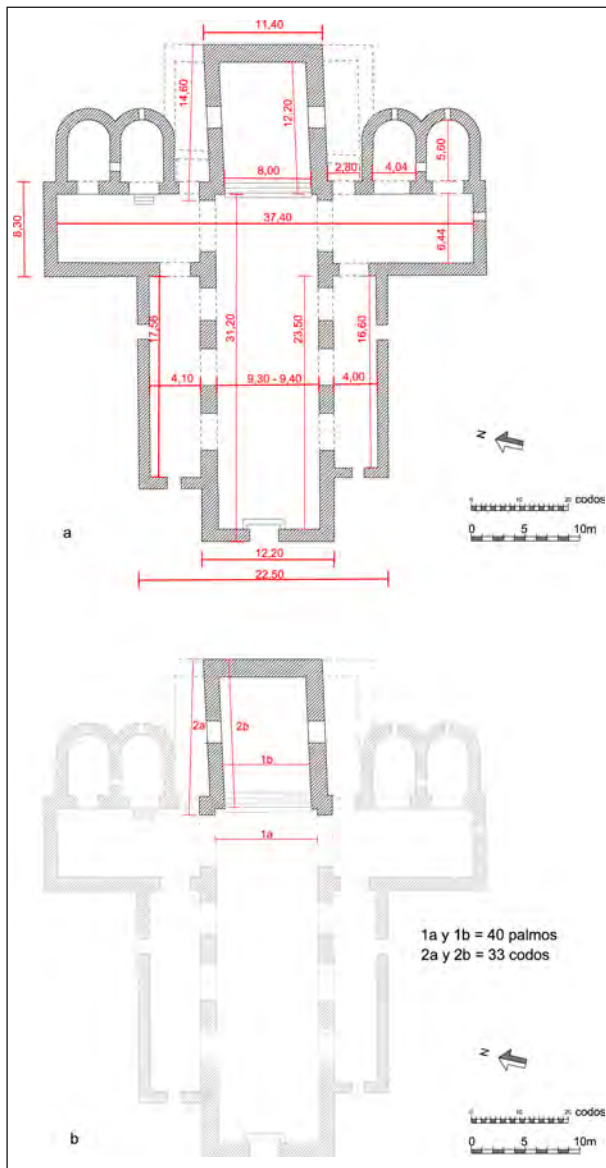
6a. Planta de la fase del siglo X con cotas actuales (planimetría de la autora). 6b. Posibles medidas del monje Garsias (planimetría de la autora).
